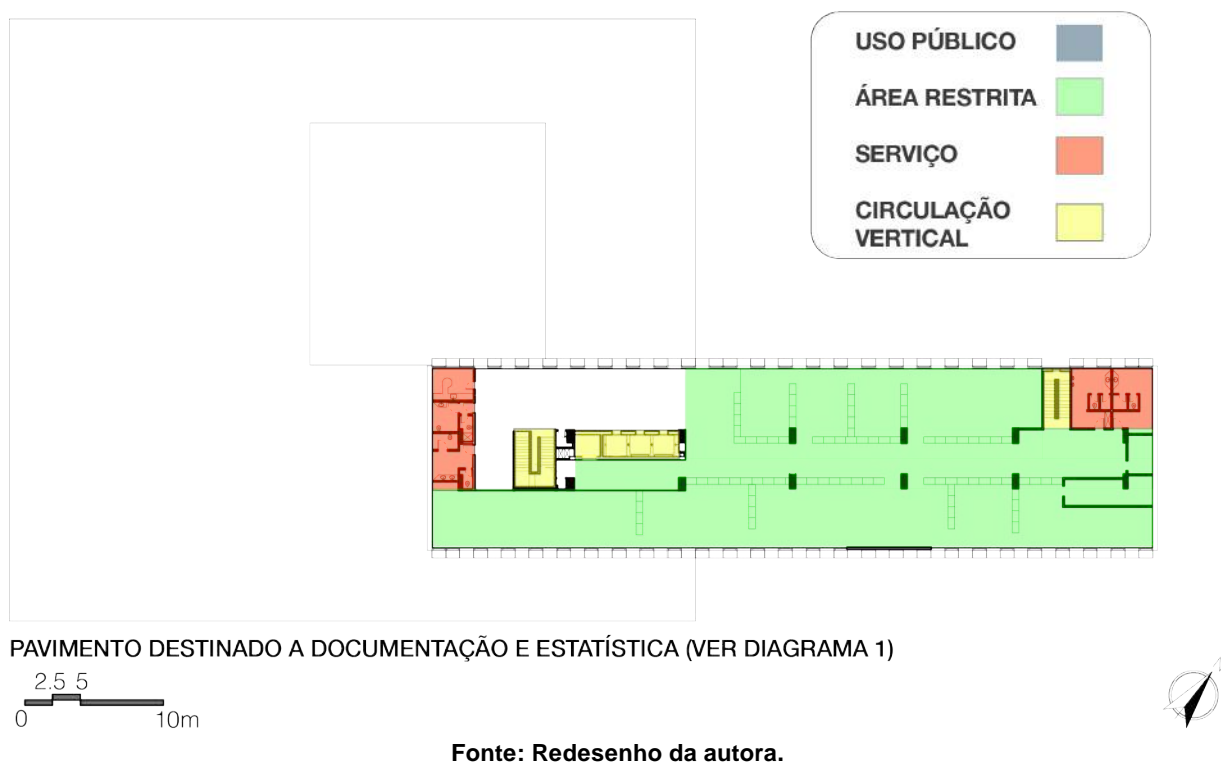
Planta de setorização do sétimo pavimento do edifício da Reitoria da UMG.
